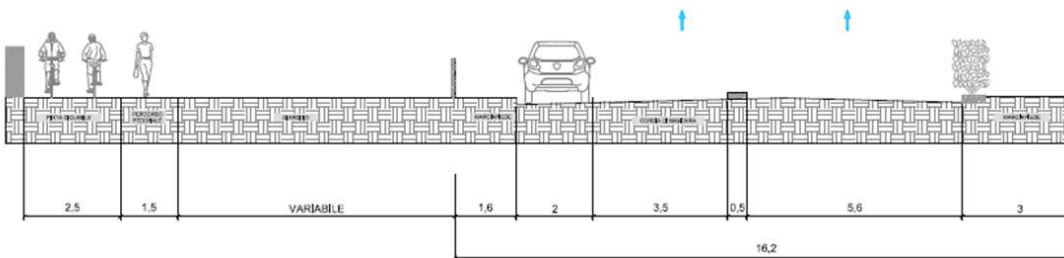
Sezione tipo di Lungarno Don Minzoni, stato di progetto
